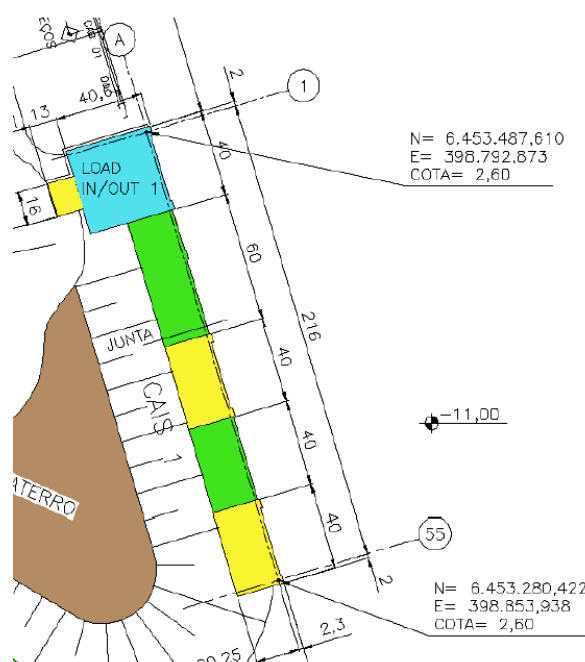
Planta Cais 1-Estaleiro Honório Bicalho
